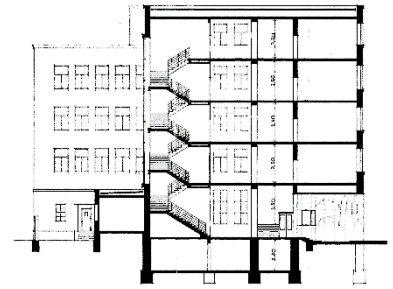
Sección por el vestíbulo de entrada del edificio de los Borobio, Zaragoza, 1936.
